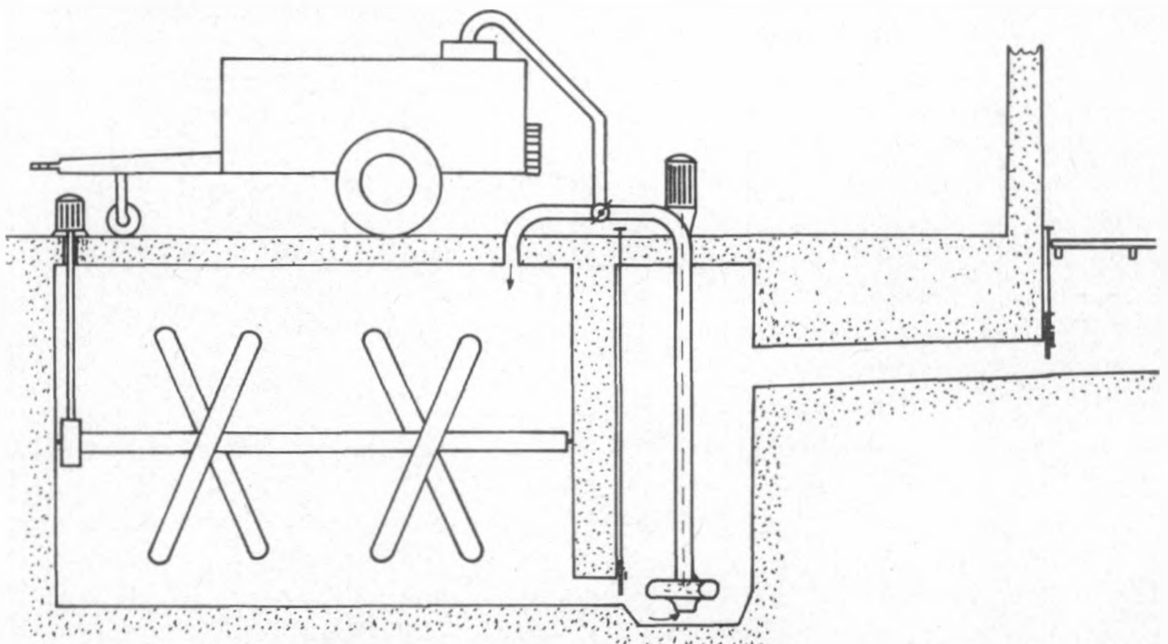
Hauptgrube mit Flügelrührwerk, Vorgrube mit fest eingebauter Mixpumpe
